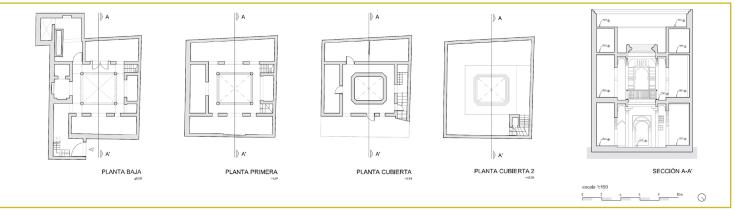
Plantas y corte de la casa dar Safar (fuente: Los autores).
